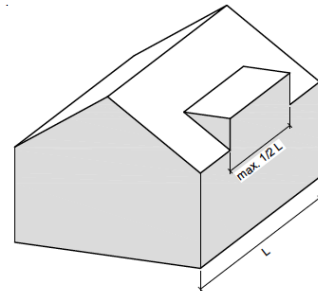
schematische Darstellung Dachaufbauten gemäss neuPBG (1/2 der Fassadenlänge)
